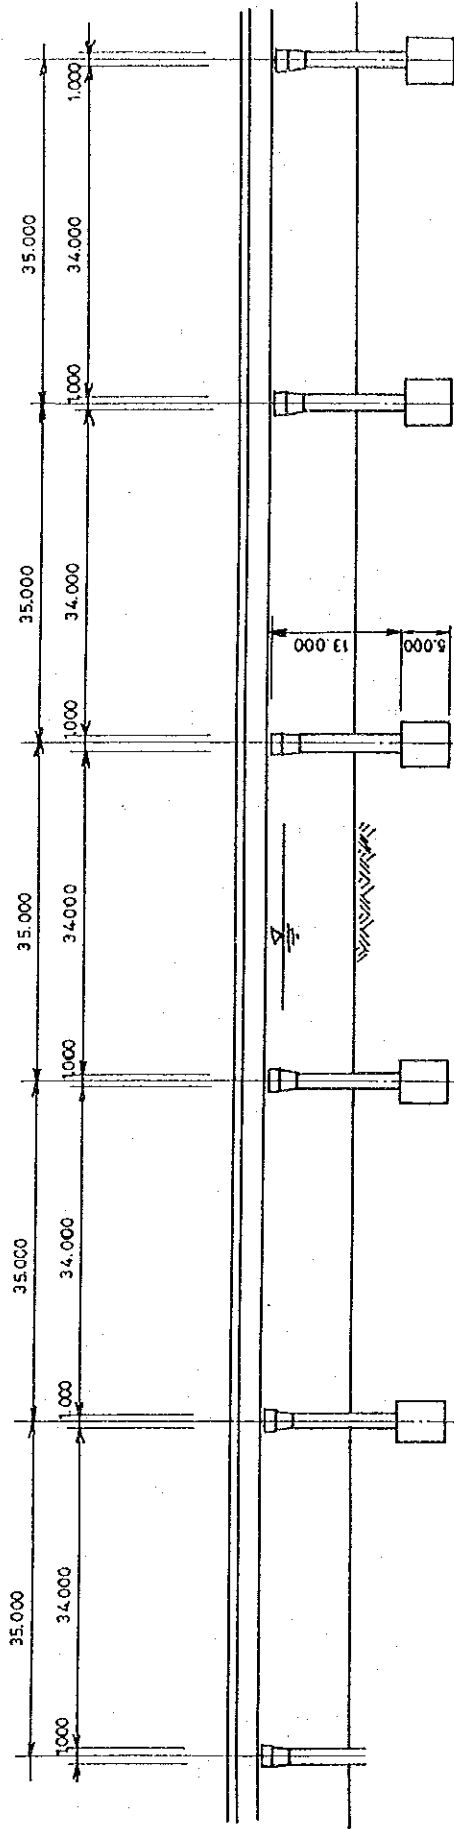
Perfil Longitudinal de Tramos con Vigas Simplemente Apoyadas
